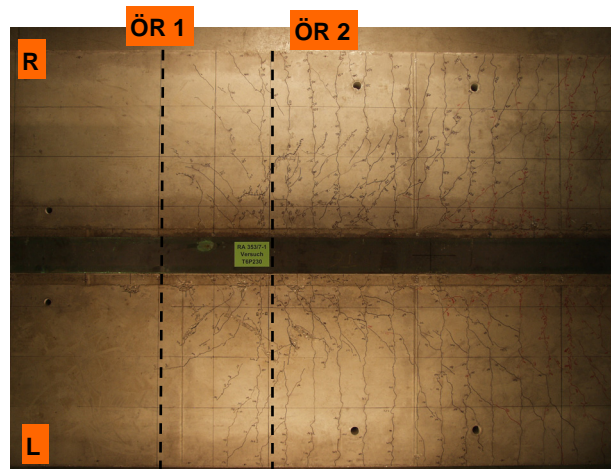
Rissbild auf der Betongurtunterseite
